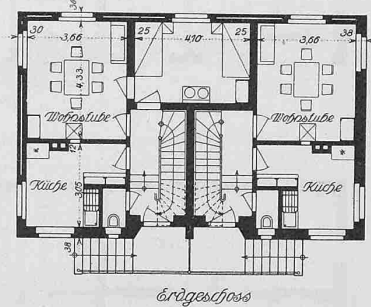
bis 8. Grundrisse Typ II. — 2 Einfamilienhäuser zu je 4 Zimmern. — 1 : 250.
